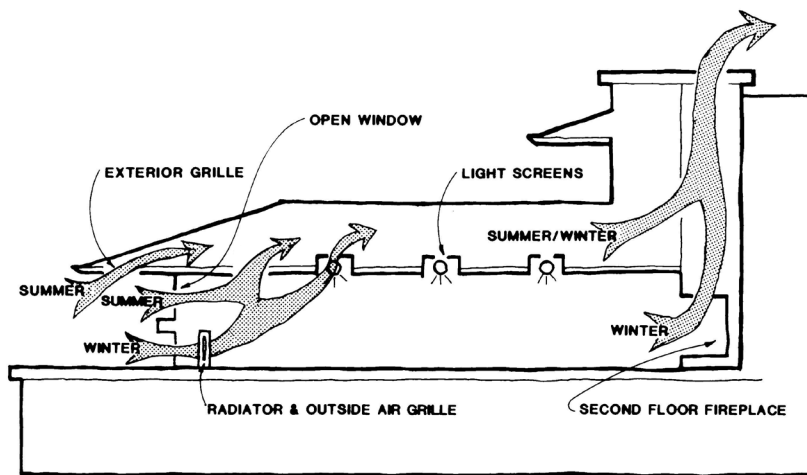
Secção esquemática do sistema de ventilação da Robie House.
